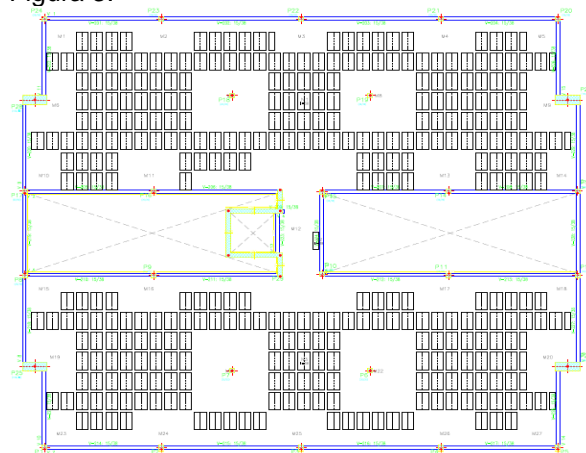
Planta de fôrmas do pavimento tipo. Fonte: Próprio autor, 2015.
